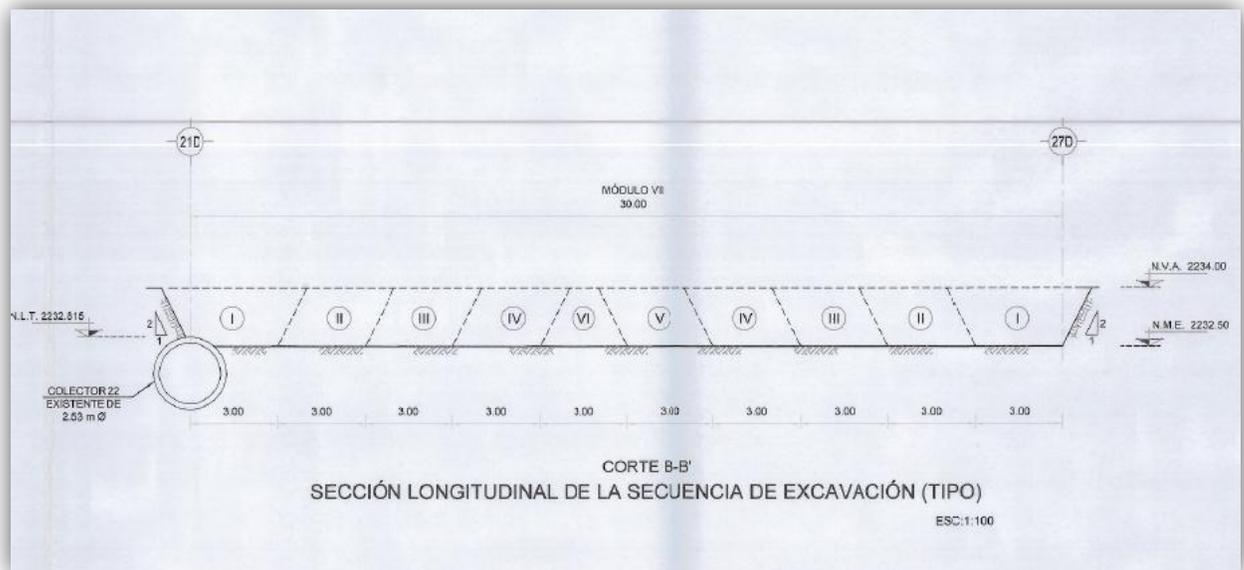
Sección Longitudinal de la Secuencia de Excavación Tipo. Módulo IV, V, VI y VII.
